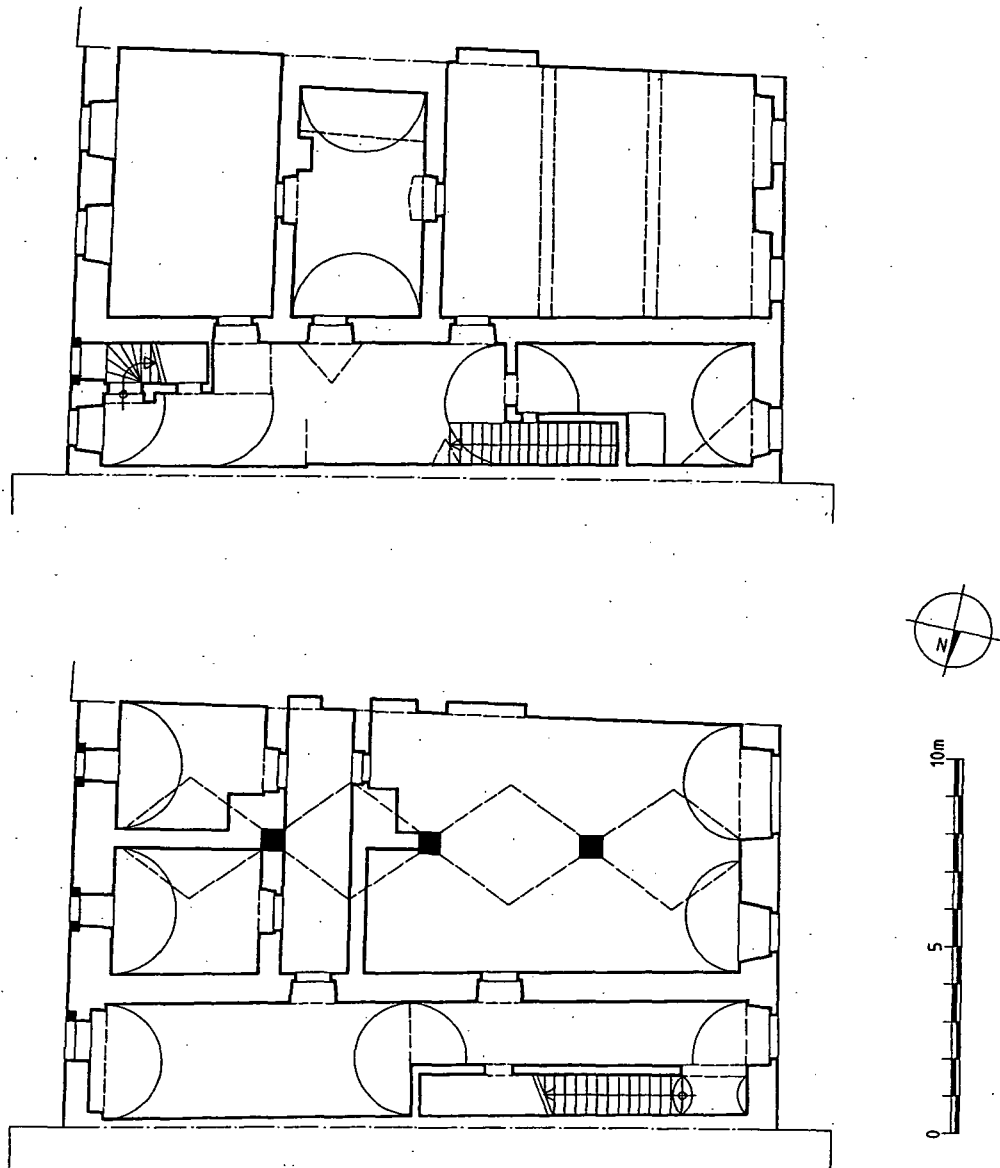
Stadtplatz 14 – Grundrisse Erdgeschoss, Obergeschoss (1:200).
